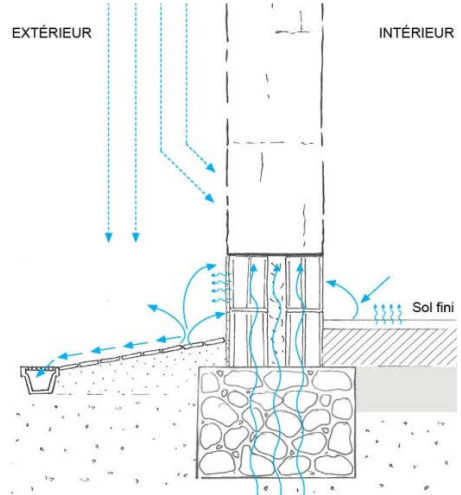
Fondation pierres, soubassement\* isolant, sol en pierre, canal drainant
